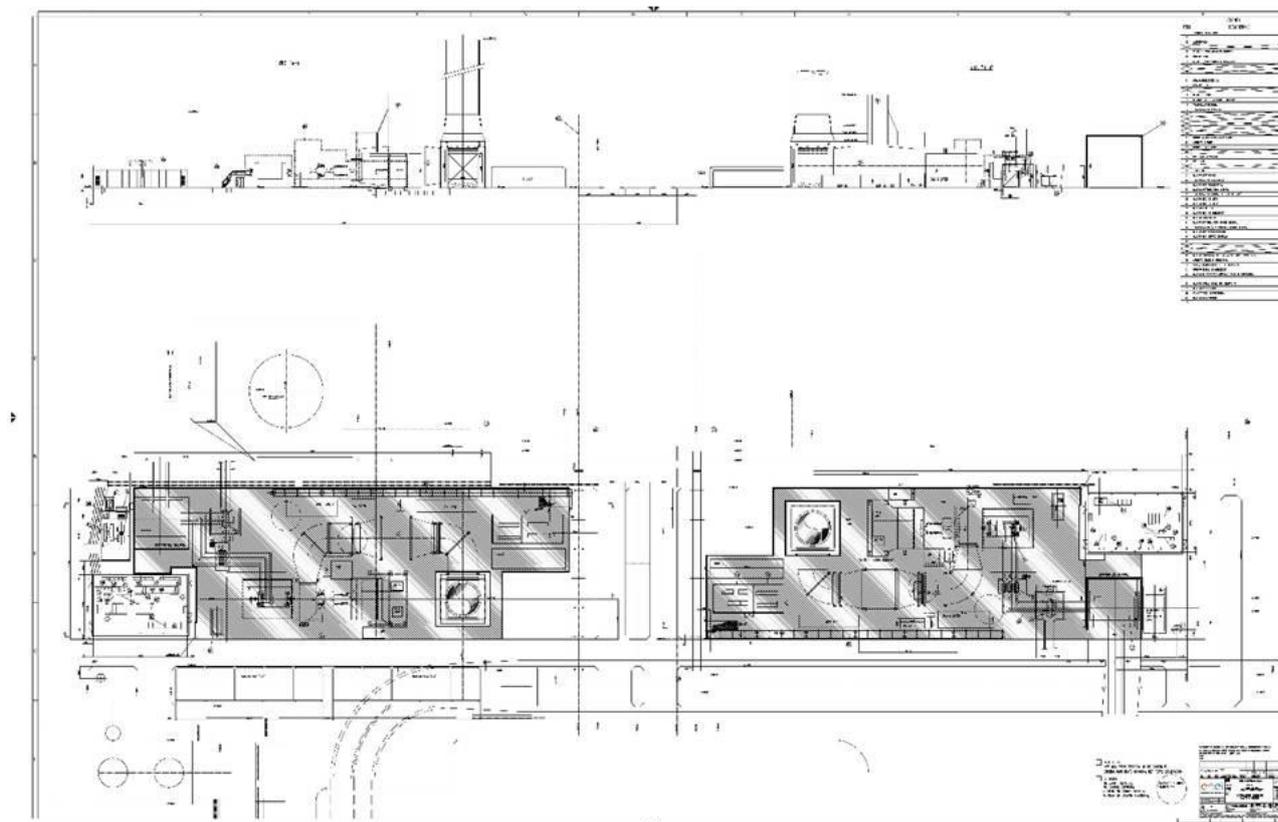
Planimetria delle aree da sottoporre a trattamento
